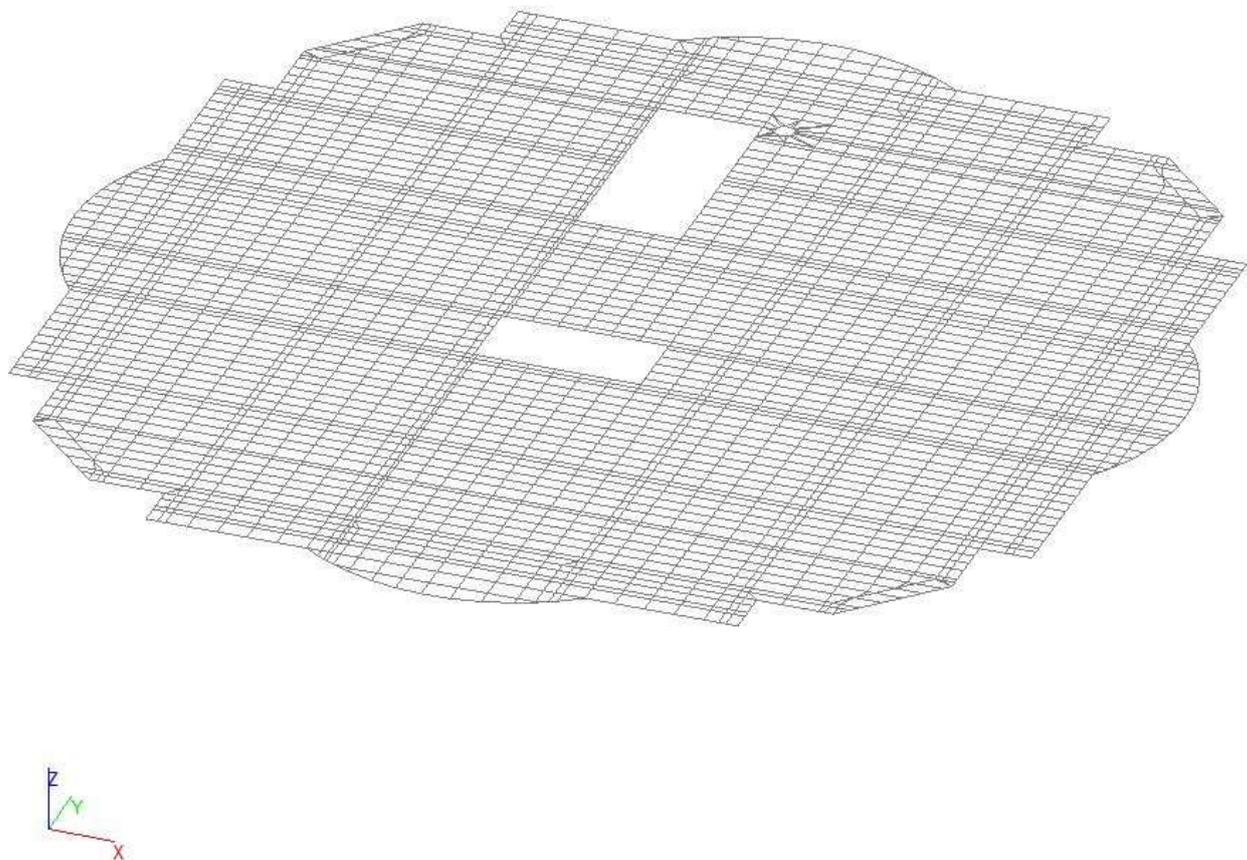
Кінцвоелементна розрахункова схема плити
